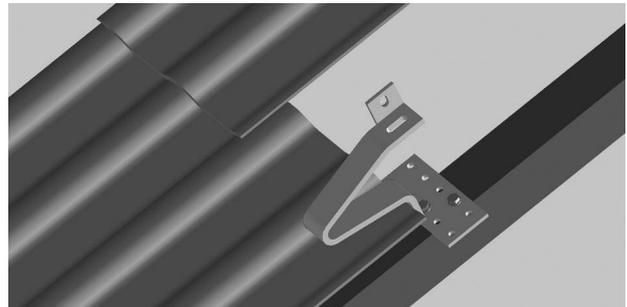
Dachhakenmontage (Abb. Dachhaken Art.-Nr. 1361262)
